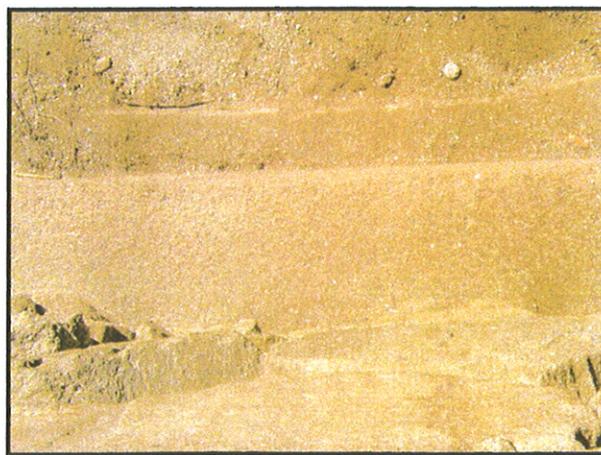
Detalle de argamasa en recalce y terreno adyacente.
